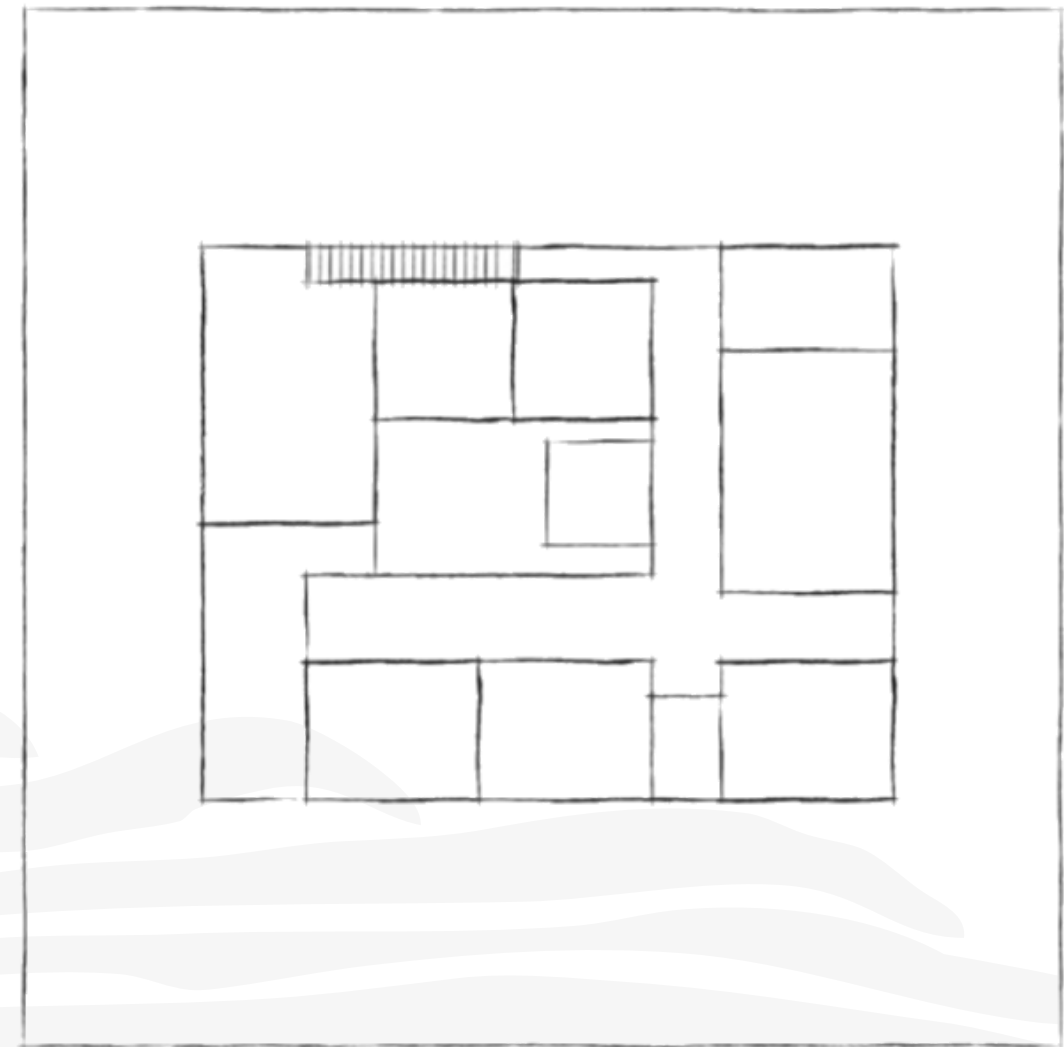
Zoneamento em planta. Fonte: Elaboração própria da autora.
